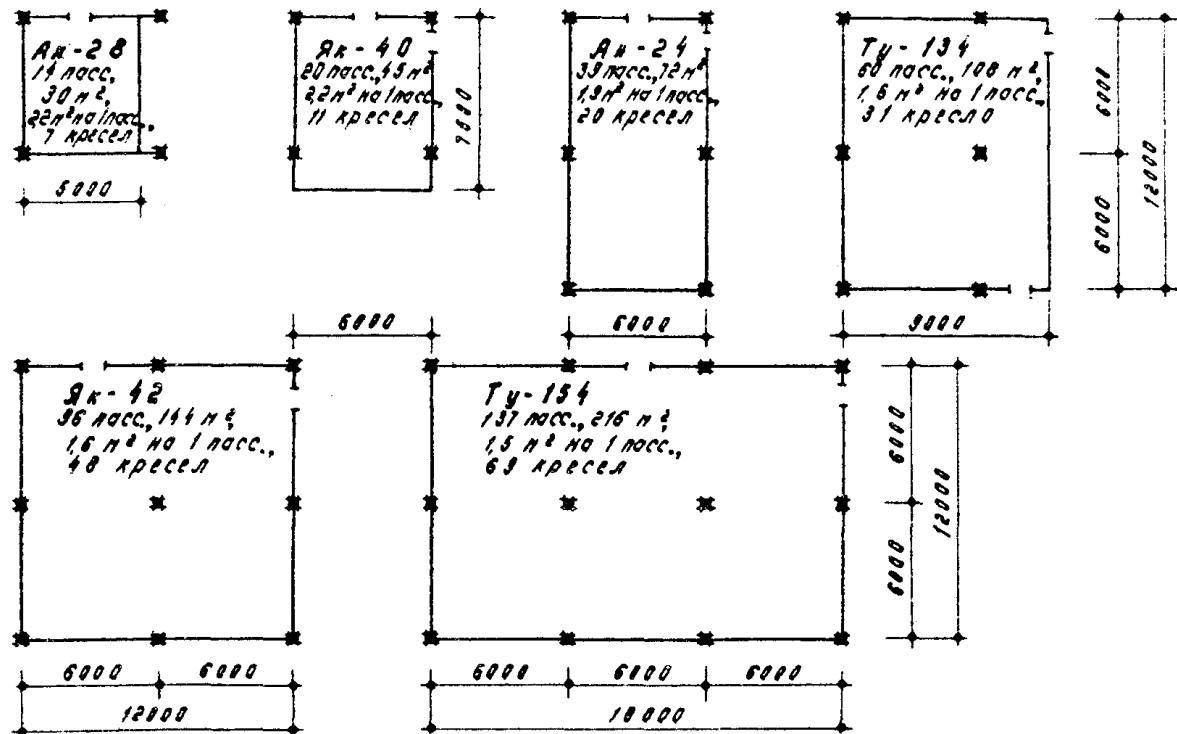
Габаритные схемы помещений ожидания посадки (накопитель) пассажиров, вылетающих самолетами Ан-28, Як-40, Ан-24, Ту-134, Як-42, Ту-154
